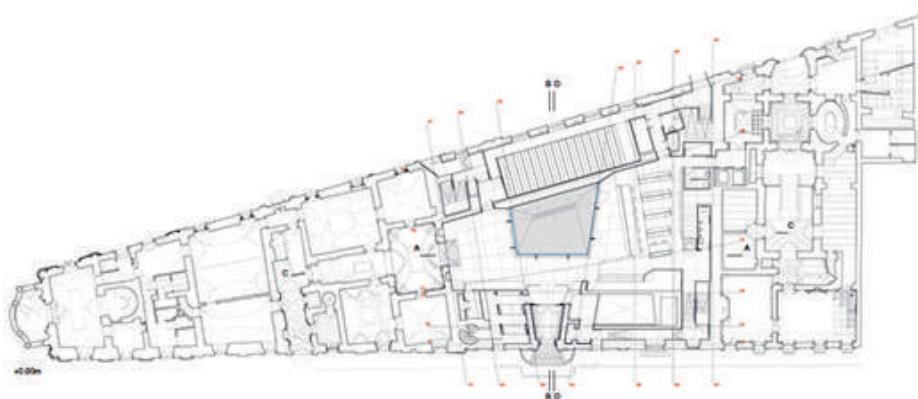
Navarro Baldeweg, Juan. Plano de planta de la nueva Biblioteca Hertziana.
